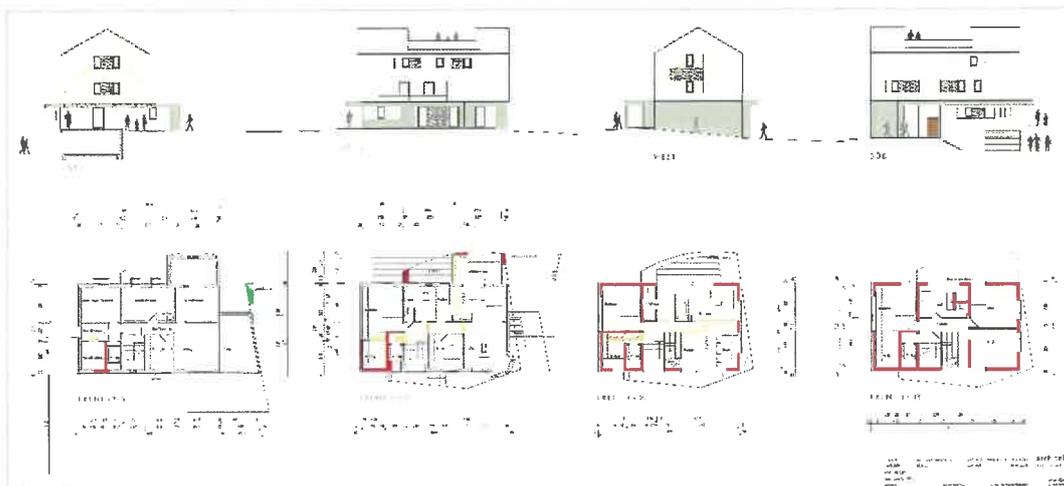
Neuhausstraße 4 – Grundrisse und Ansichten, 30.04.2021, Architekt Patrick Saffrin
